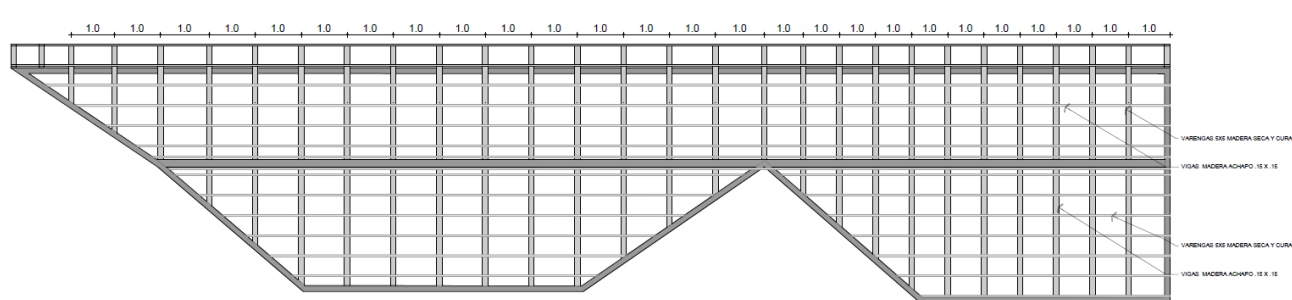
Propuesta Estructura Cubierta. Fuente: Propia
